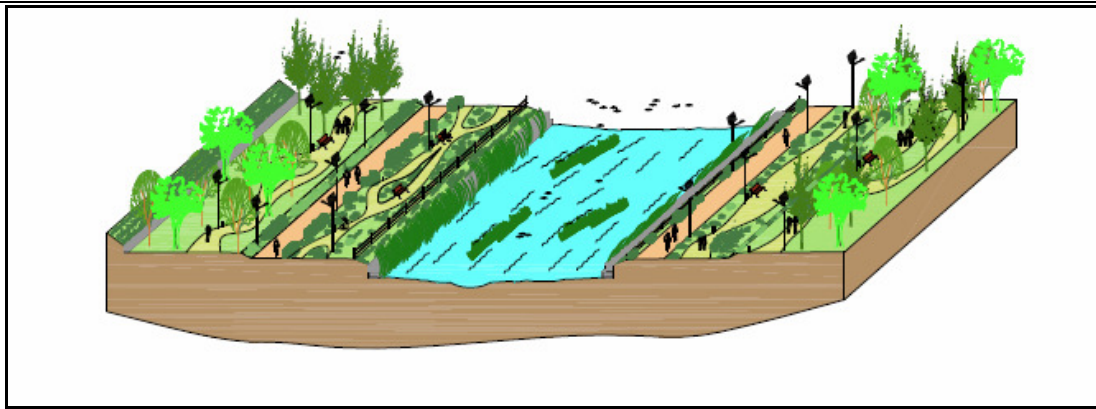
IMAGEN DE SECCIÓN TIPO DE ENCAUZAMIENTO
